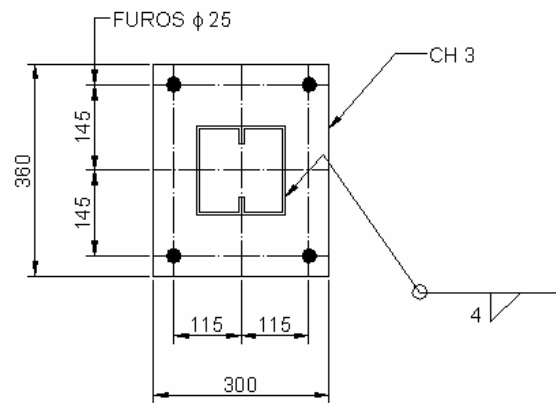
Detalhe construtivo da ligação Pilar – Fundação [3]
